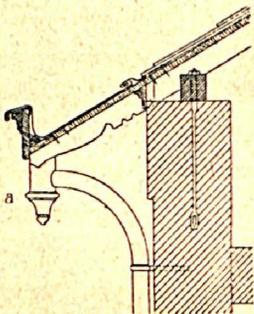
gibt das Beispiel einer Rinnenconstruction bei einem Dach mit sichtbaren Sparrenköpfen. Das Abfallsrohr erhält bei a einen kleinen Schlammfang.
